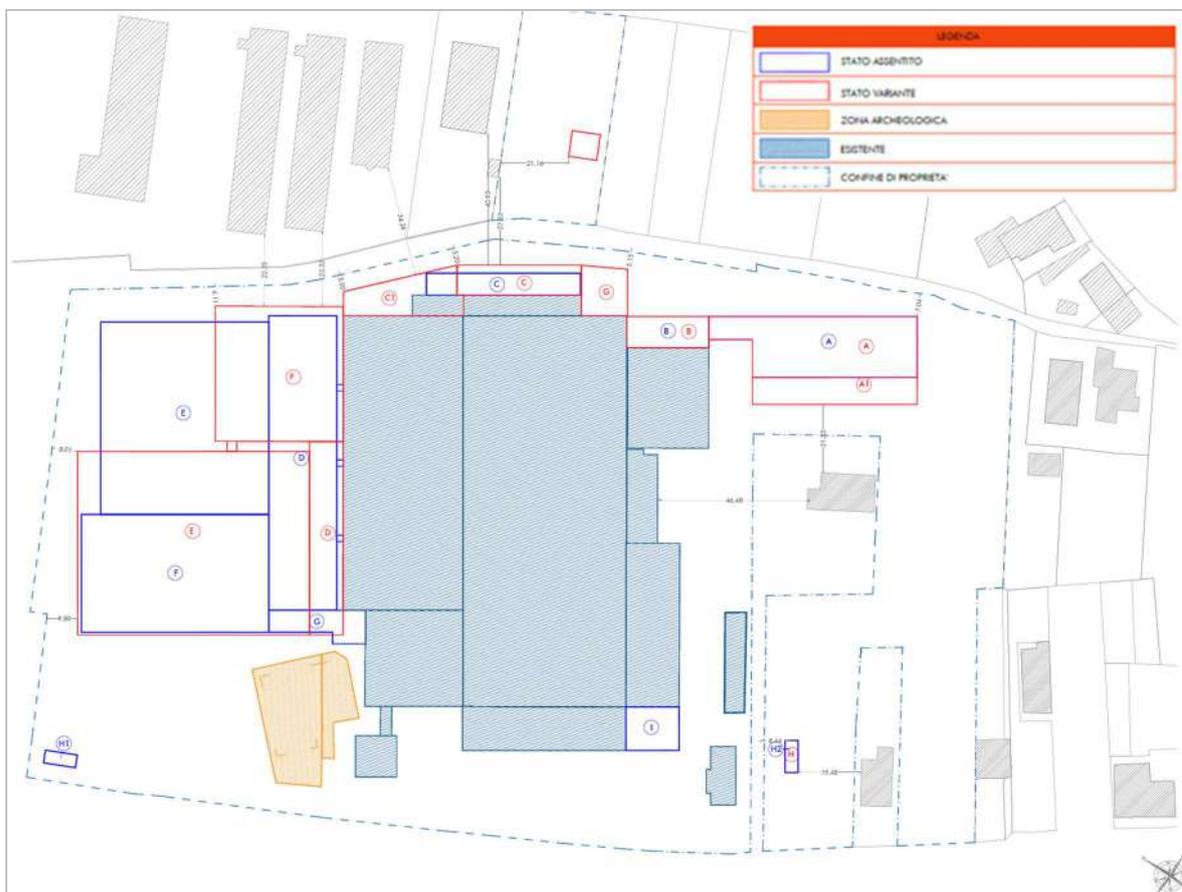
Confronto tra il layout autorizzato con D.D.160/2024 (blu) e precedenti e il layout di progetto dell'insediamento (rosso)
